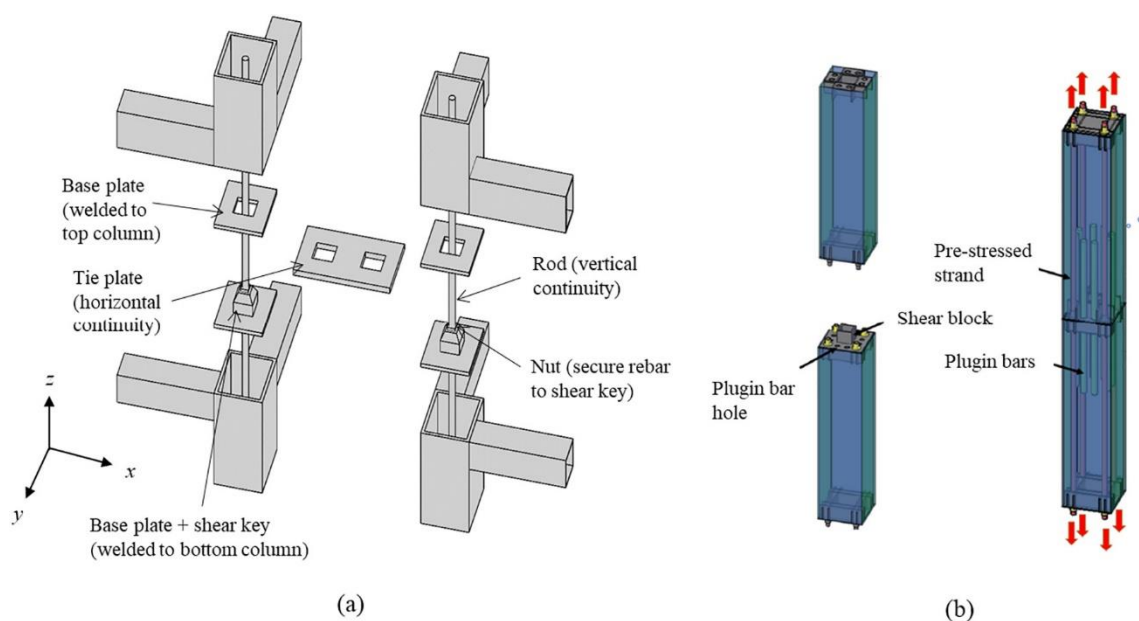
Conexiones columna – columna a) sistema de *Shear key* con barra vertical b) sistema de pretensado con barras. Fuente: (Liew et al. 2018).
